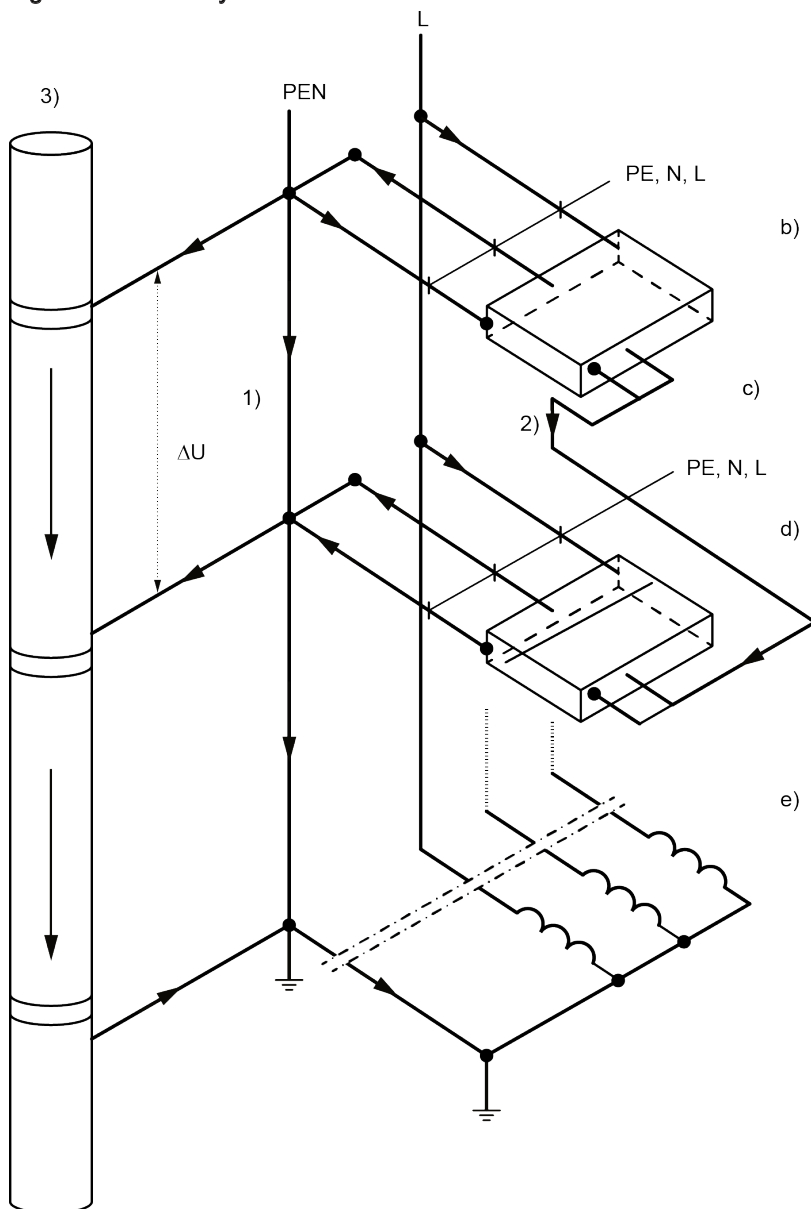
Système TN-C-S dans une installation existante de bâtiment
